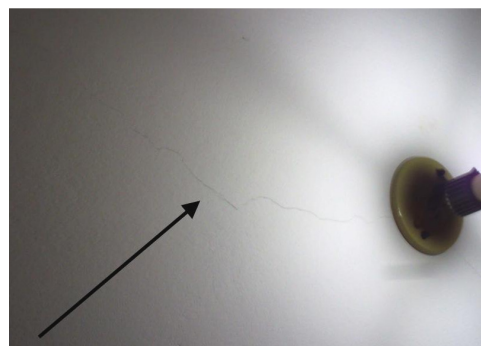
Fissuração na laje dos apartamentos.
